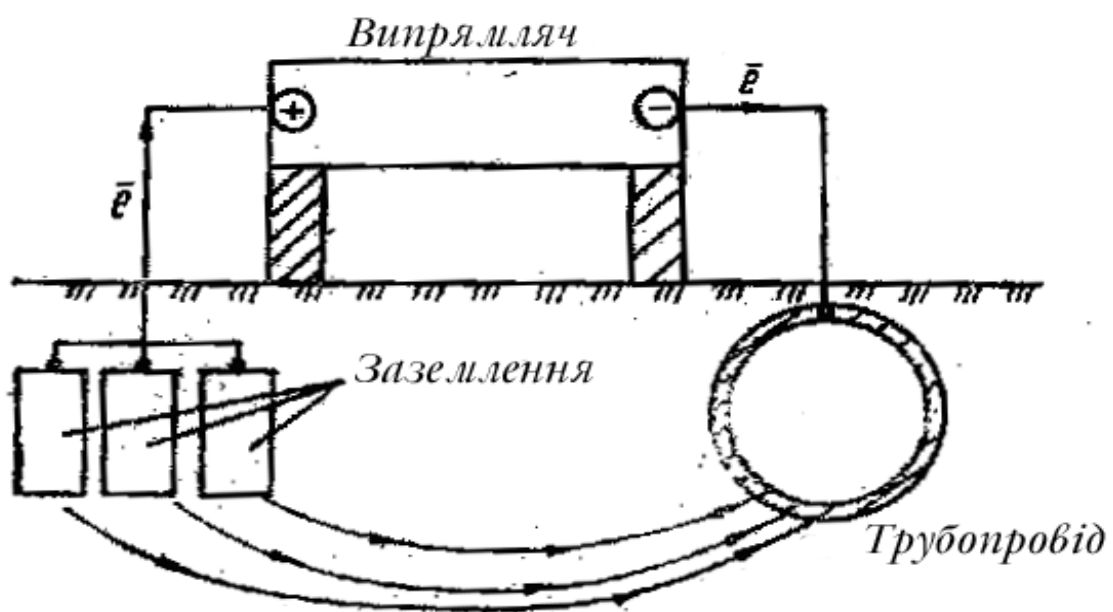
Схема катодного захисту металевих конструкцій
